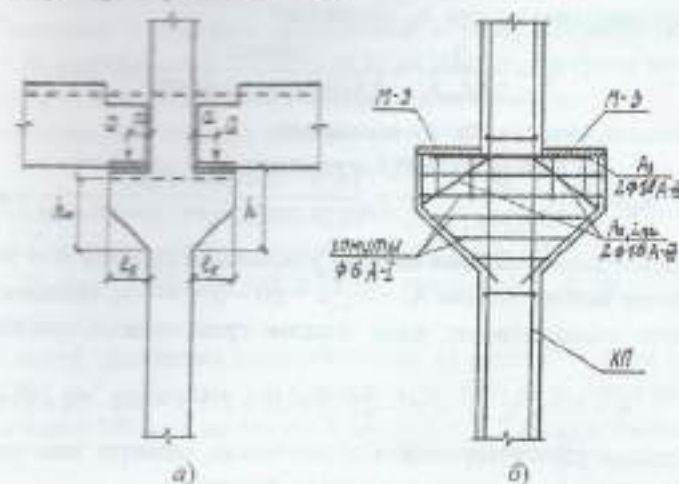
Консоли для опирания сборных железобетонных ригелей а — конструкция консоли, б — армирование консоли
